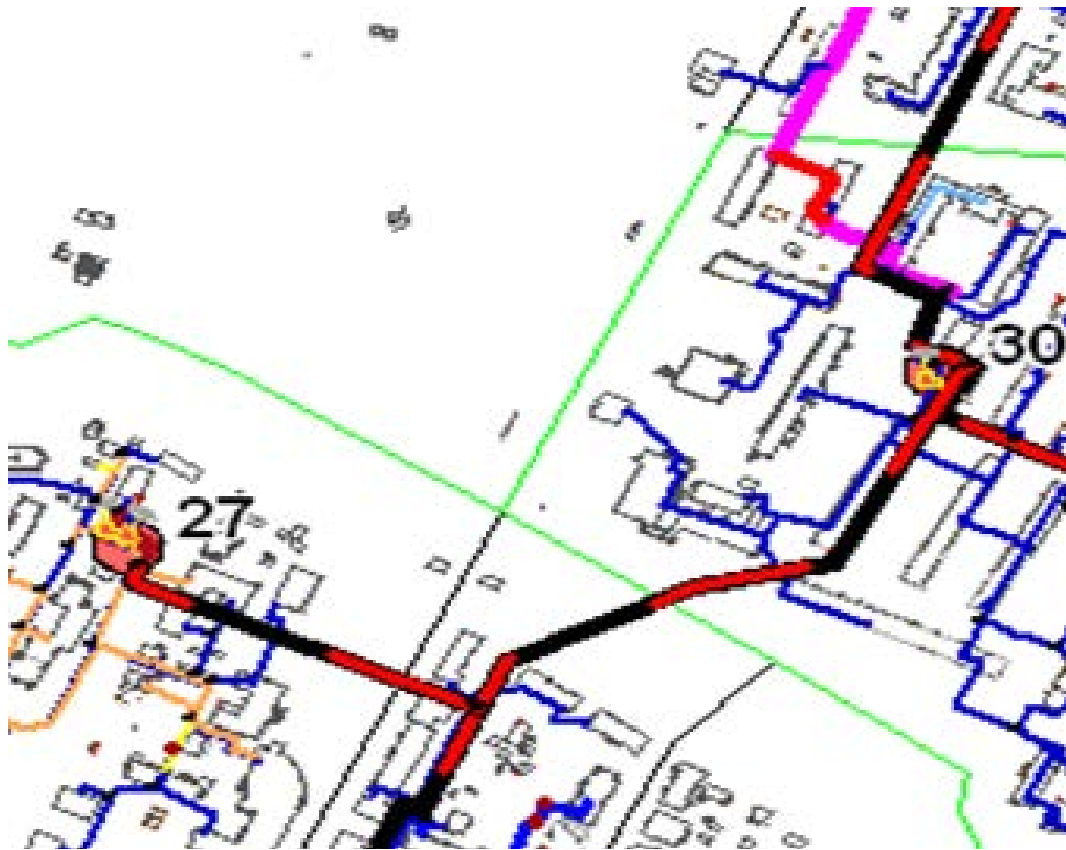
Схема прокладки трубопровода от котельной №27 до котельной №30
